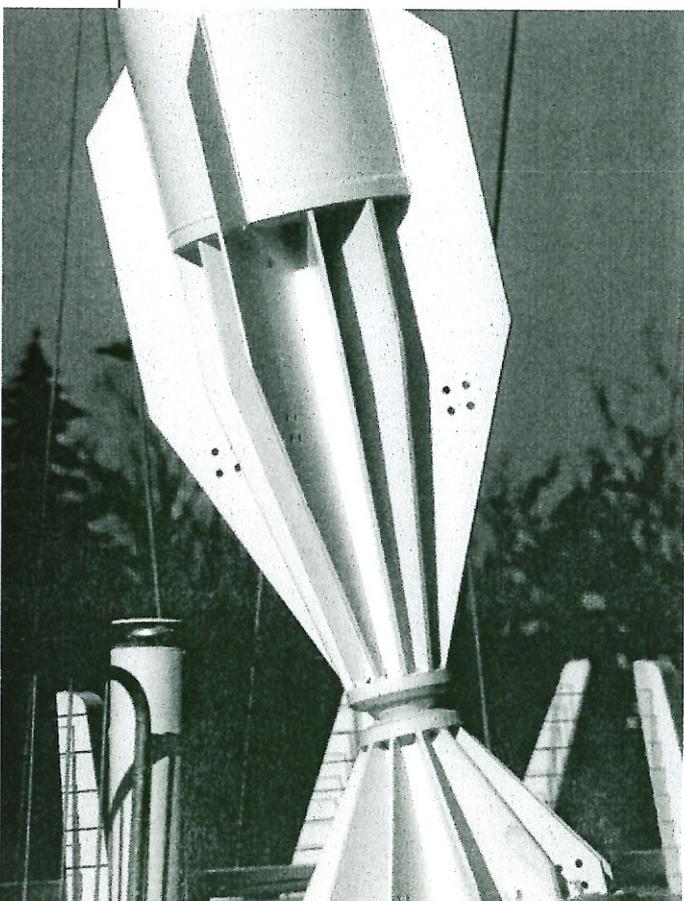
Il cavalletto d'ancoraggio: particolare A
